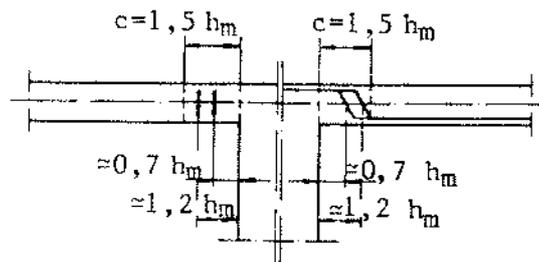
Losa sin refuerzo en el capitel de apoyo en el caso de peligro de punzonado (ejemplo de armadura de corte).
